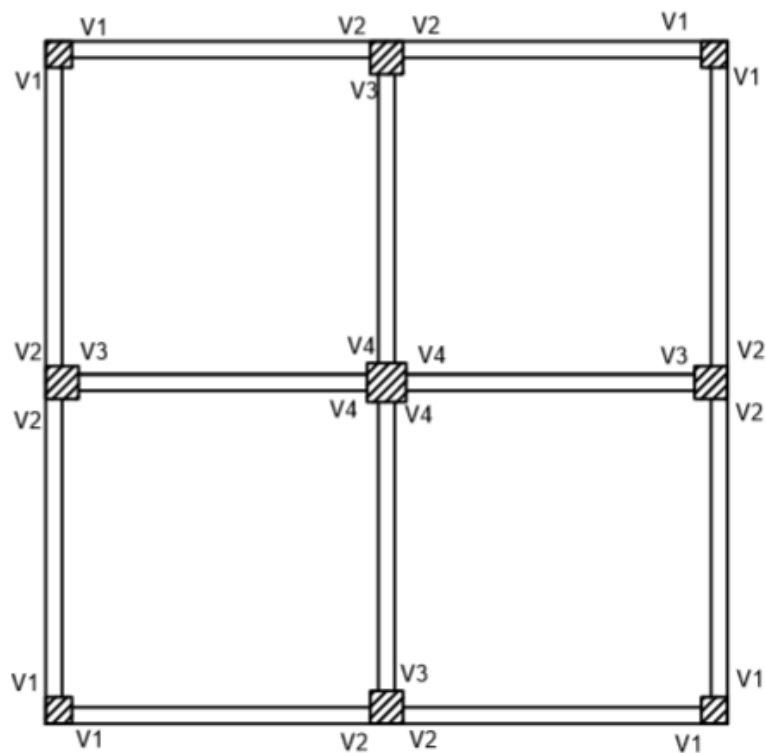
Planta do primeiro piso do Edifício 1.
